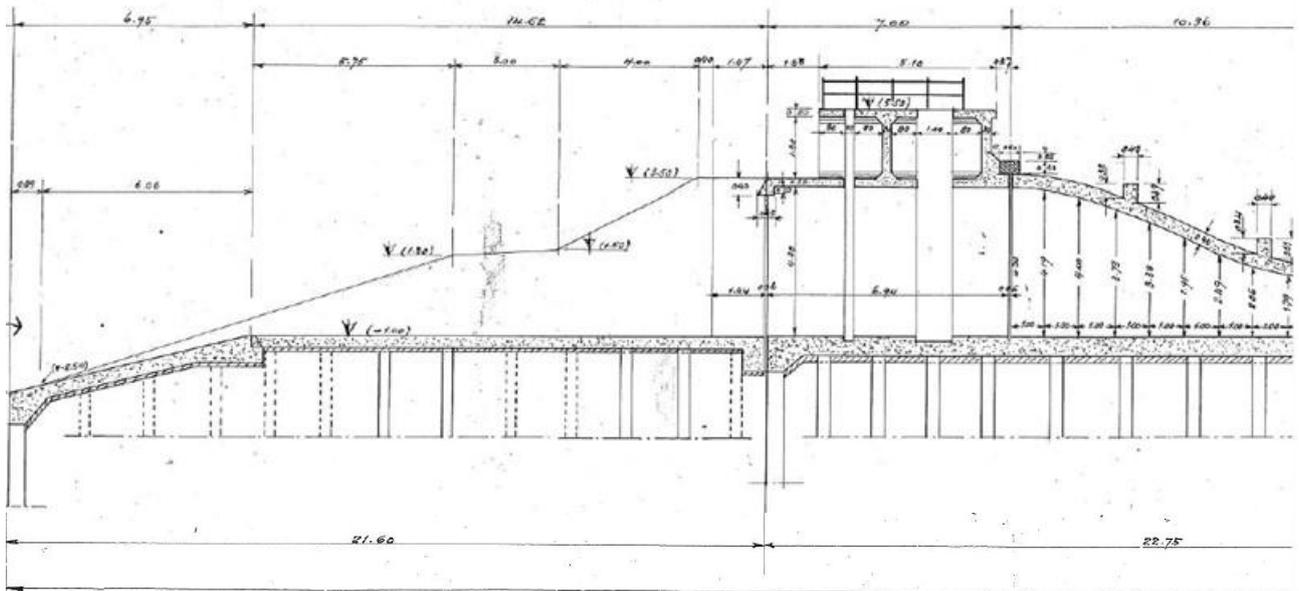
Pianta e profilo della Chiavica di derivazione da Reno (Fonte: tavole di progetto fornite da CER)
